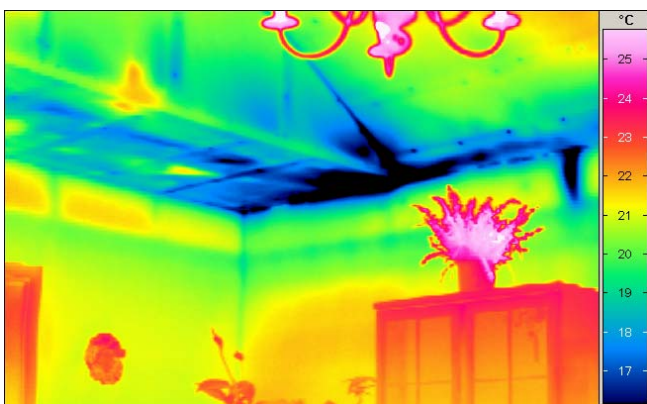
Innenthermografie – Wärmebrücken an einer Leichtbau-Deckenkonstruktion erkennbar
